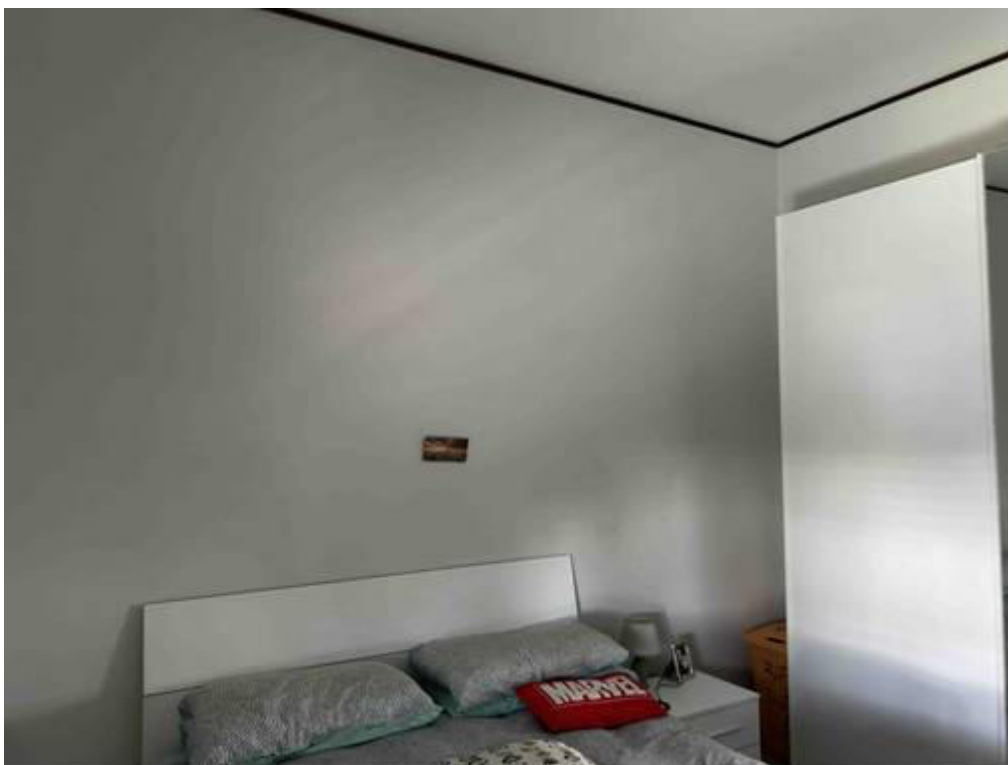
Altra foto scattata alle pareti ed al soffitto della camera. Ottimo lo stato di rifinitura.
